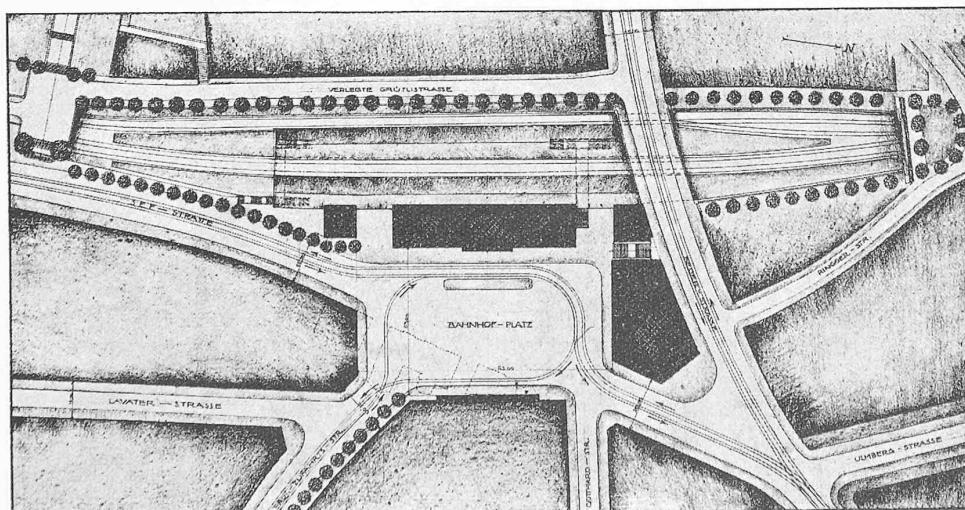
Entwurf Nr. 1. — Arch. Alb. Frölich, Zürich. — Lageplan Variante, Masstab 1:2500.
